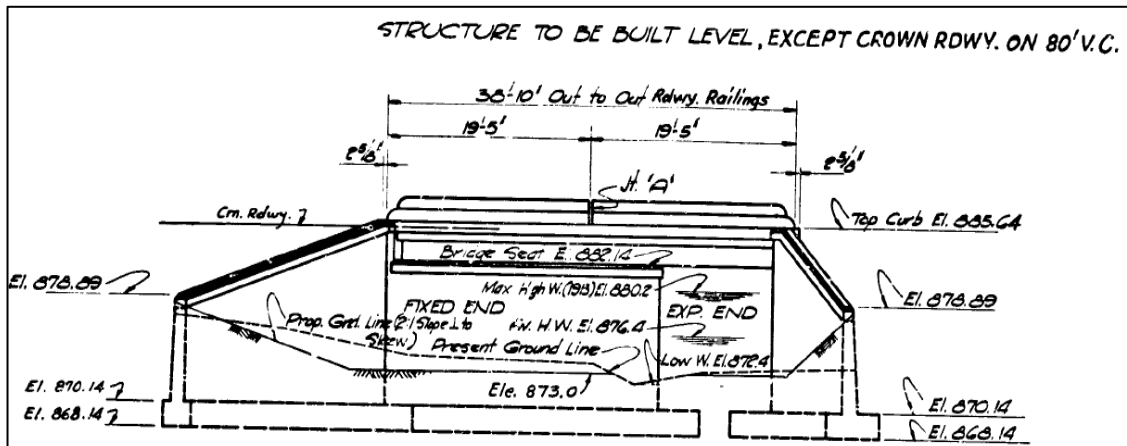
Perfil longitudinal puente No 1 – Planos de diseño.
